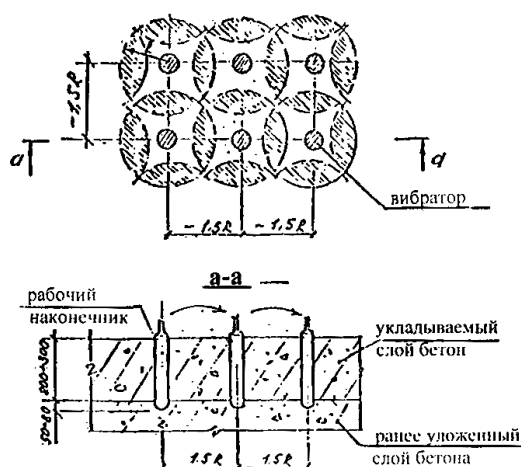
схема перестановки глубинного вибратора при бетонировании монолитных плит перекрытия
